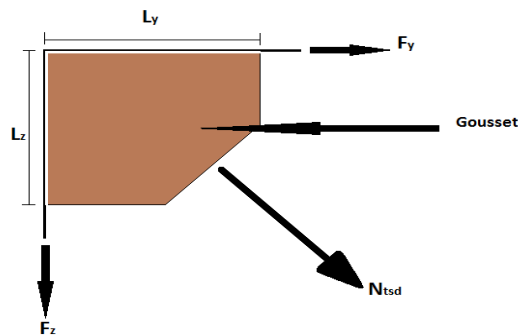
assemblage gousset nœud du portique par cordon de soudure.
